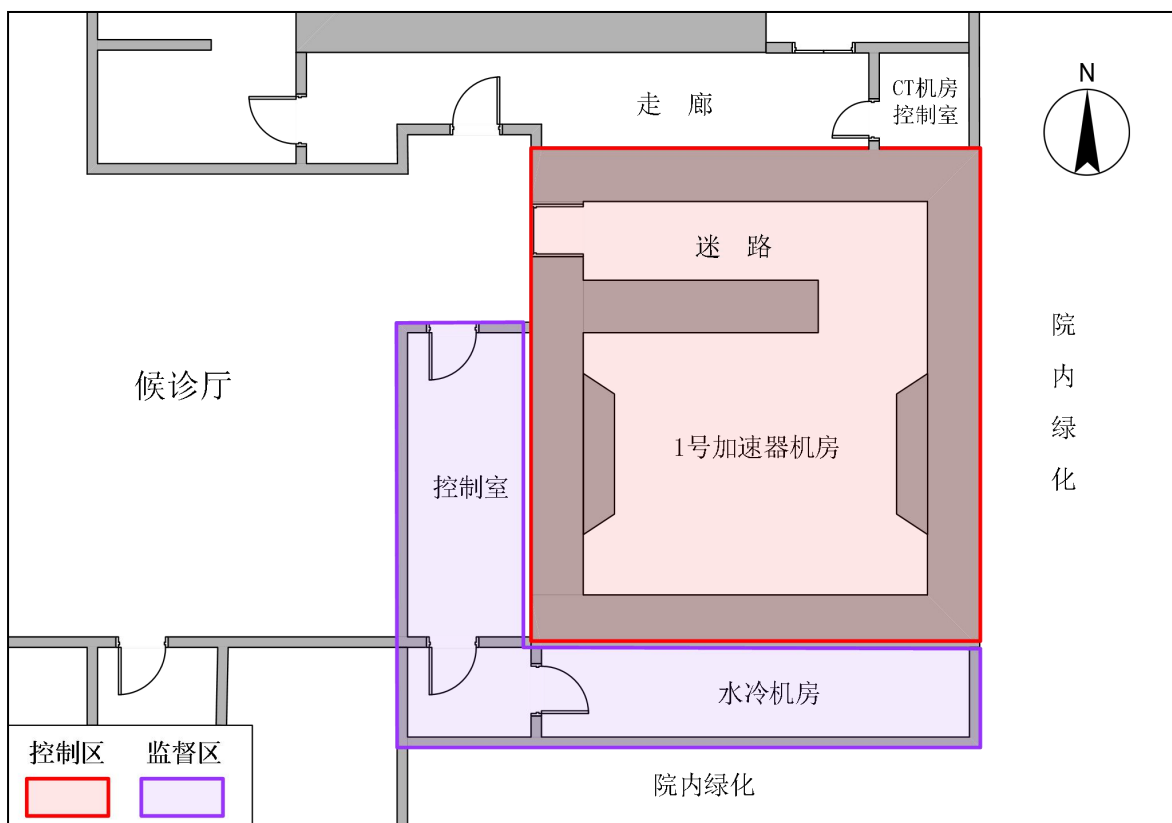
放疗楼一层 1 号加速器机房平面布置及分区示意图
